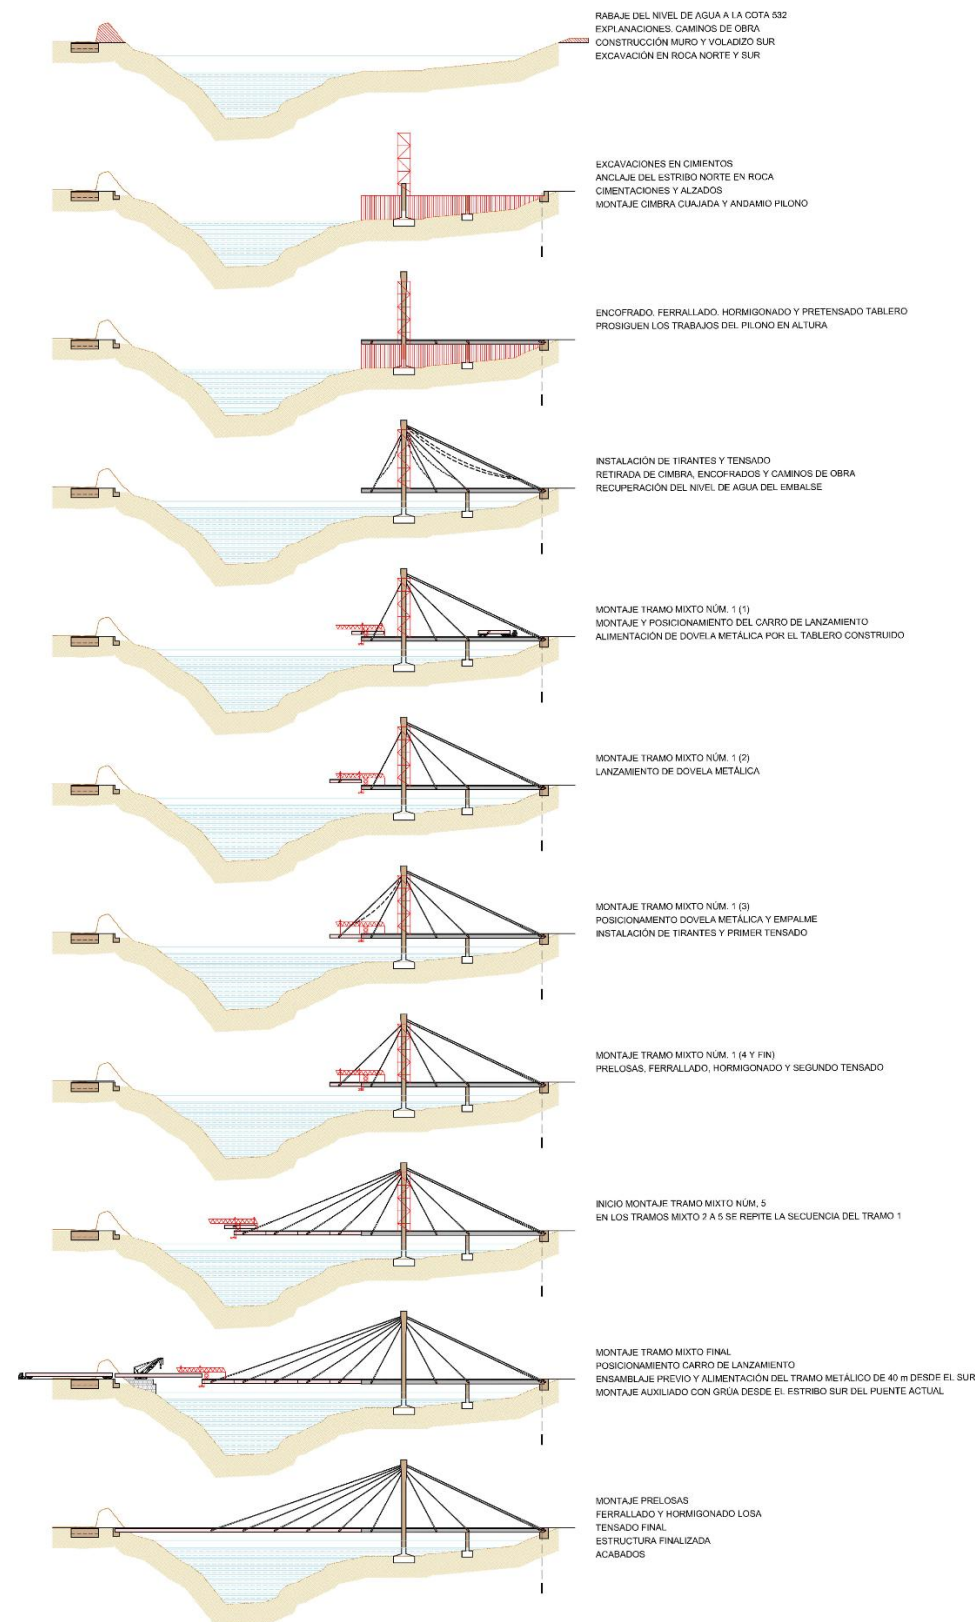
Procedimiento constructivo puente atirantado con dos apoyos.
